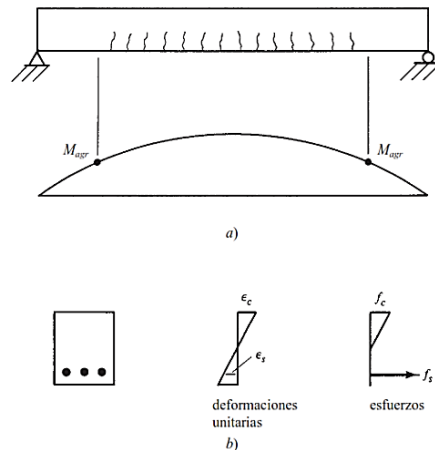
Concreto agrietado: etapa de esfuerzos elásticos.
